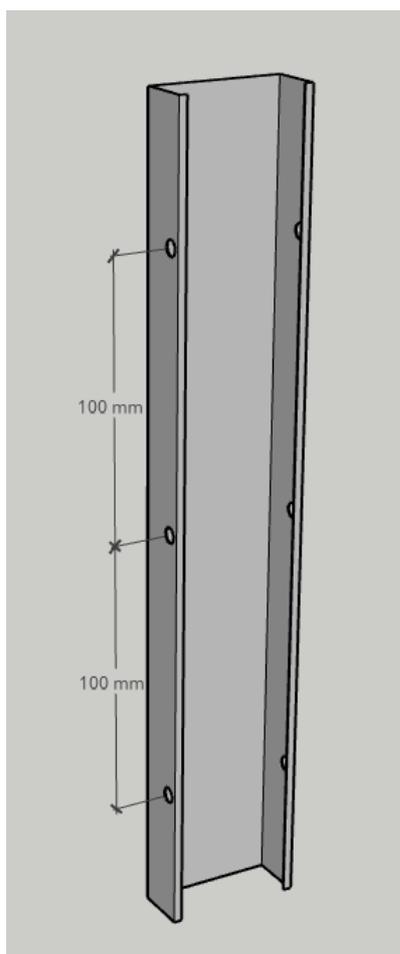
Detalhe esquemático do perfil de enrijecimento
